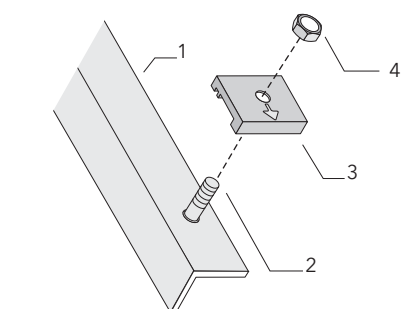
Kollektor auf Kollektorschienen befestigen (1) Kollektorträgerschienen; (2) Edelstahlschrauben M10x30; (3) Befestigungsklemmen; (4) Schraubmuttern M10; (5) Markierung; Die eingeprägte Dreieck muss immer vom Kollektorrahmen weg zeigen.
